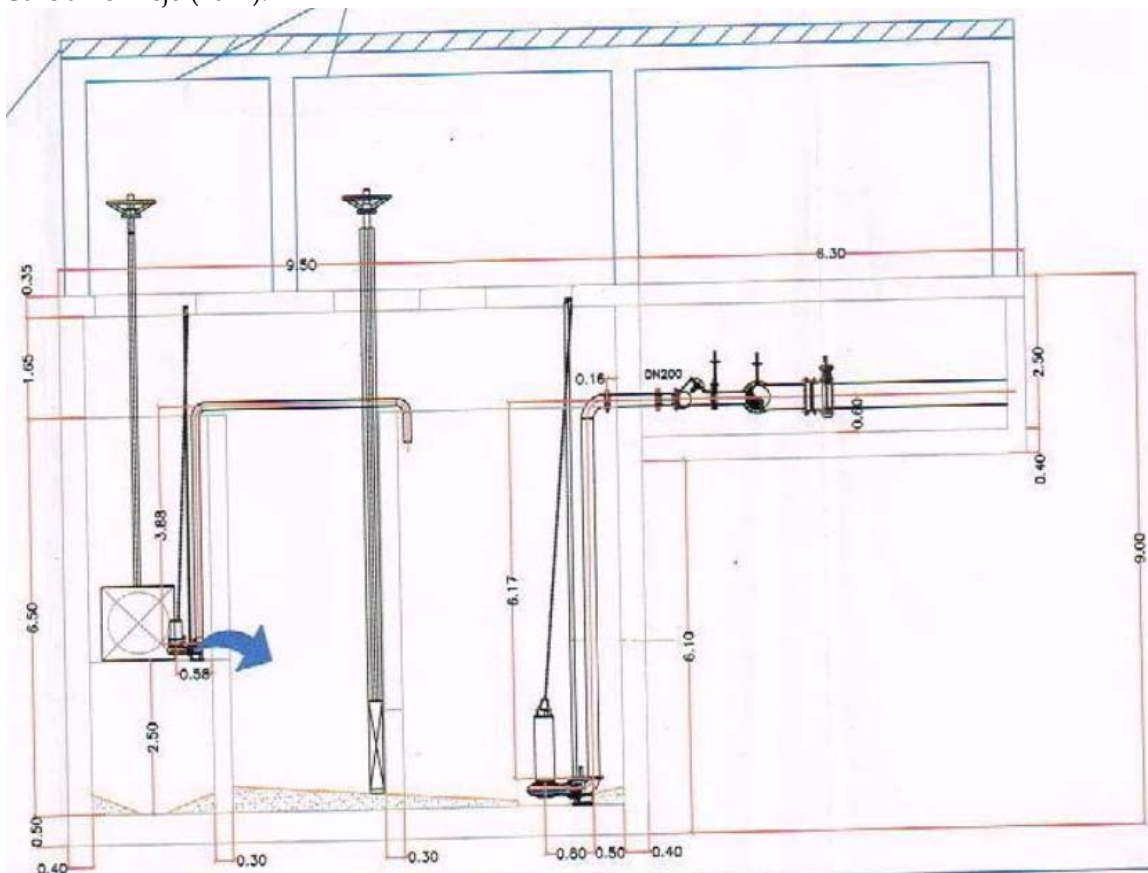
Detalle de compuertas y valvulería. Fuente: Proyecto de ejecución EBAR el Rubial. Juan García Bermejo (2011).
